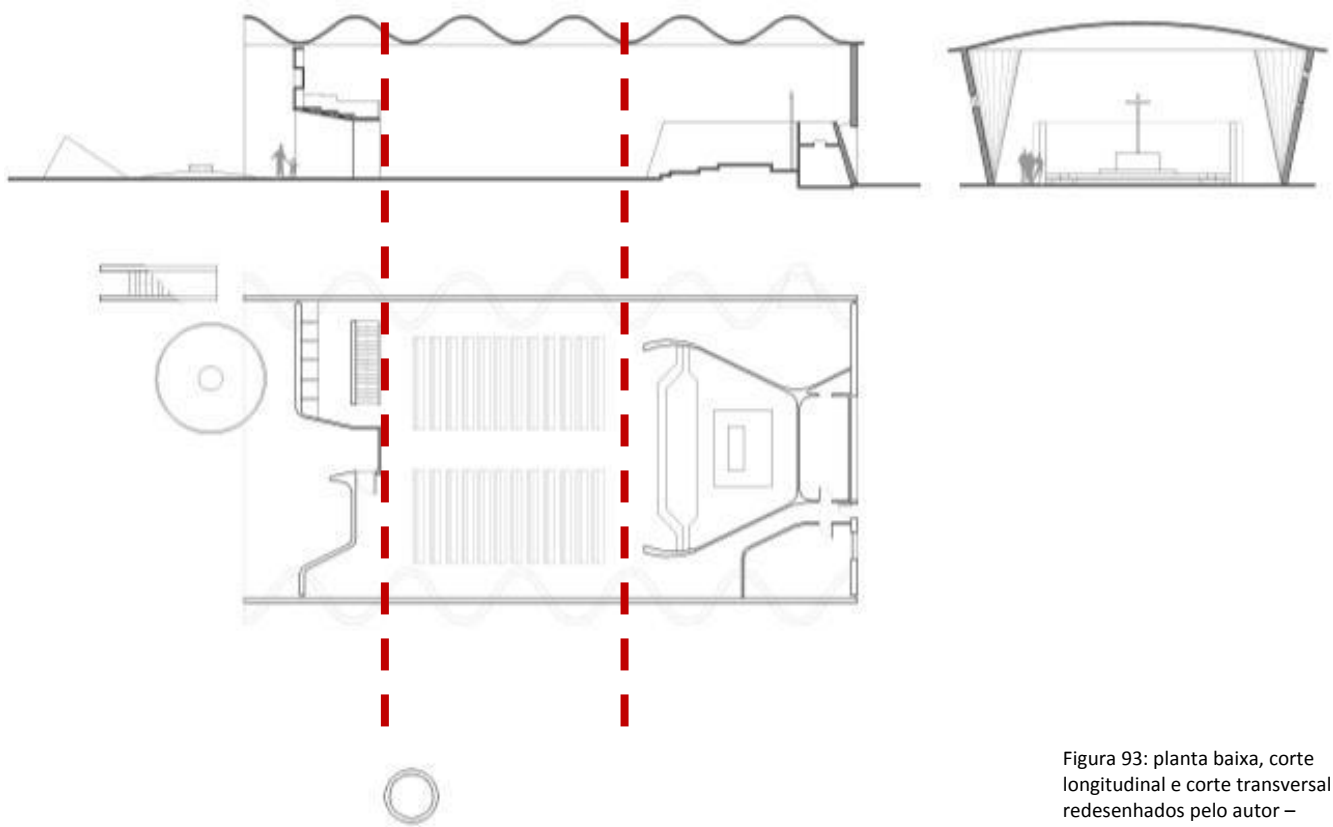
planta baixa, corte longitudinal e corte transversal redenhados pelo autor – três faixas compositivas
